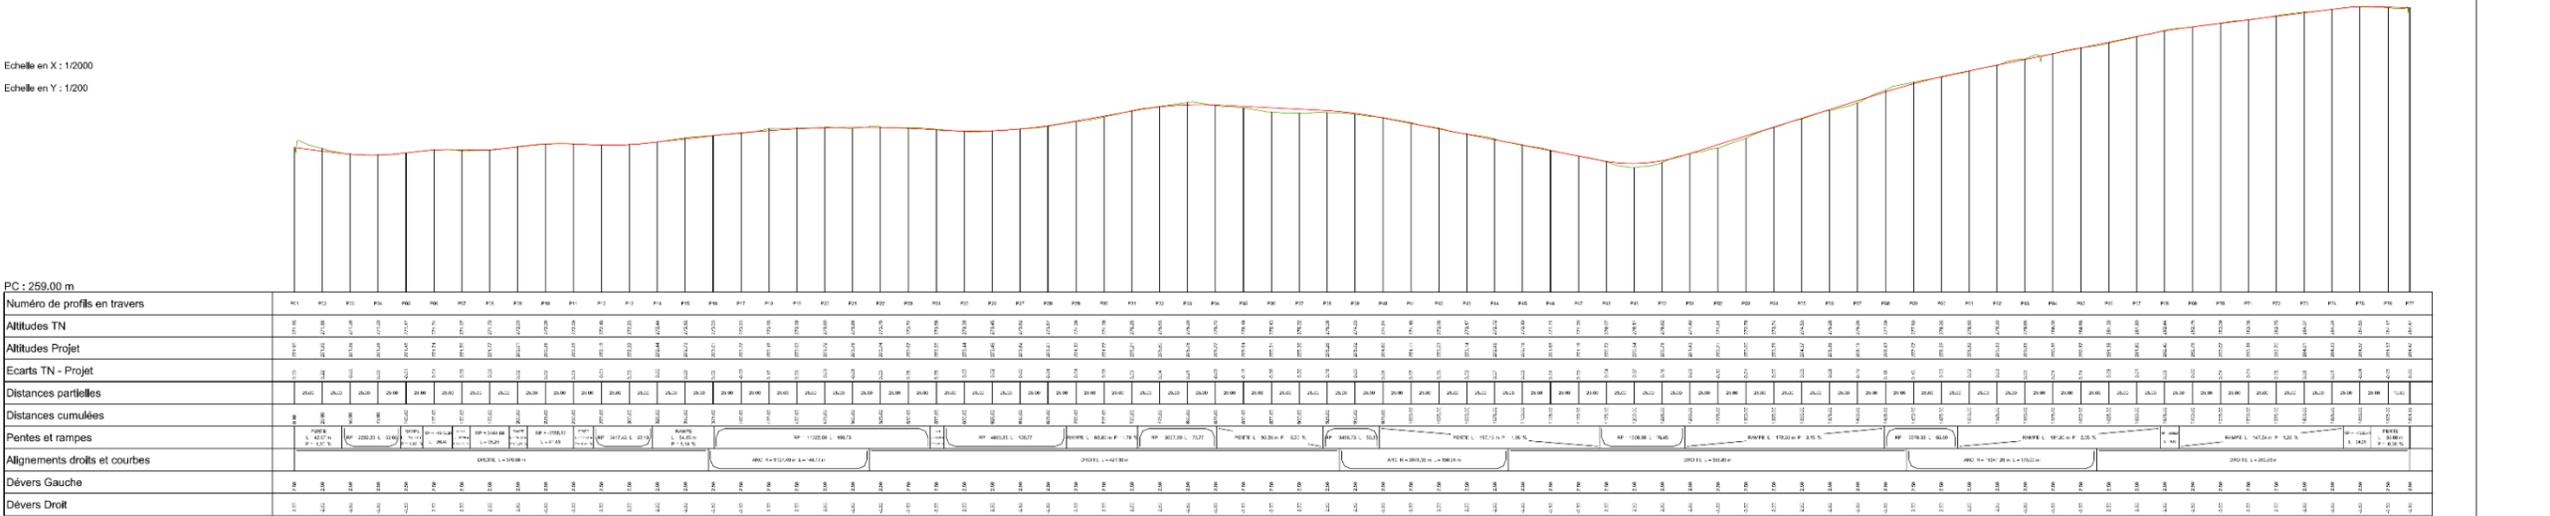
Berneuil, créneau en place élargissement de part et d'autre, profil en long
